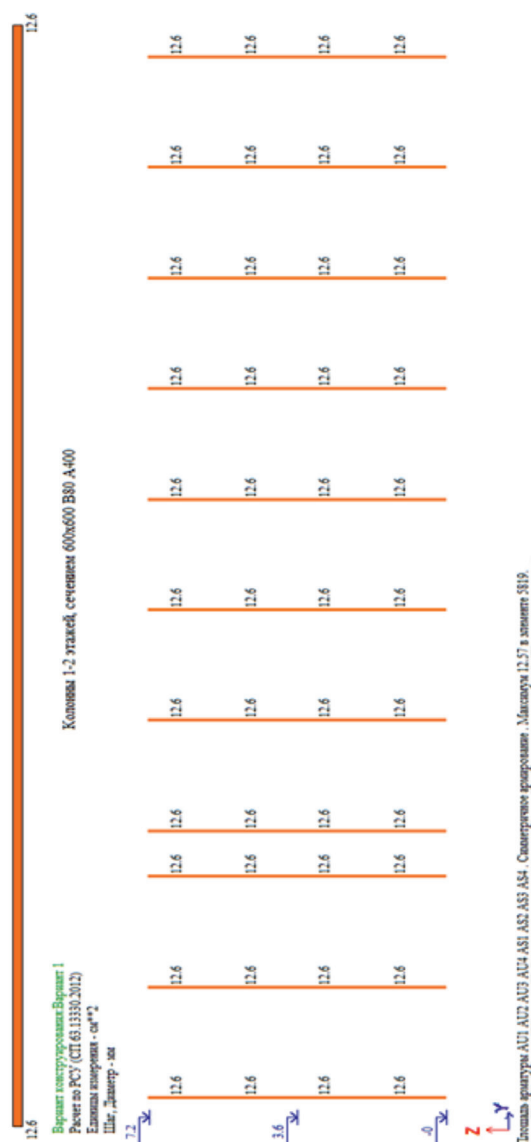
Армирование колонн 1 и 2 этажей по осям 6, 7. Сечение 600х600, бетон В80
